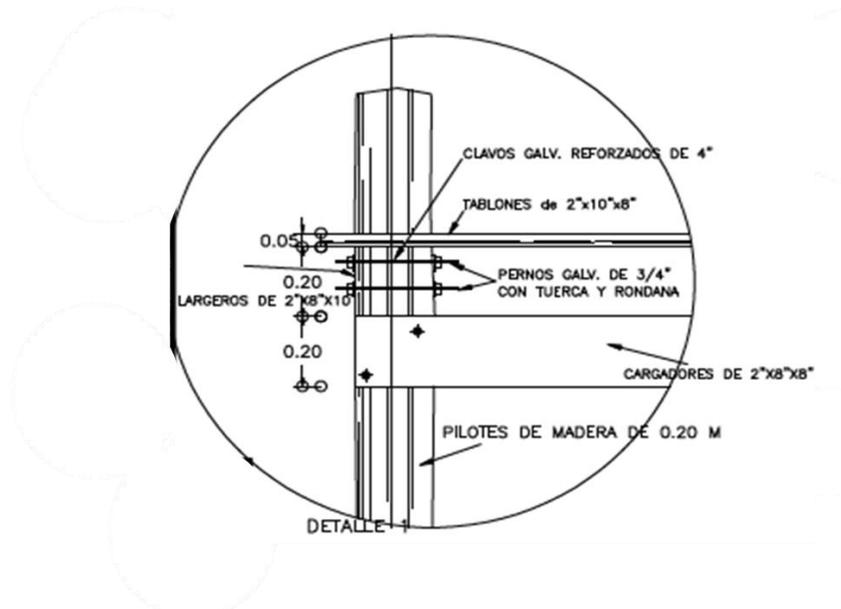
Detalle constructivo de los pilotes de la Marina Flamingo
